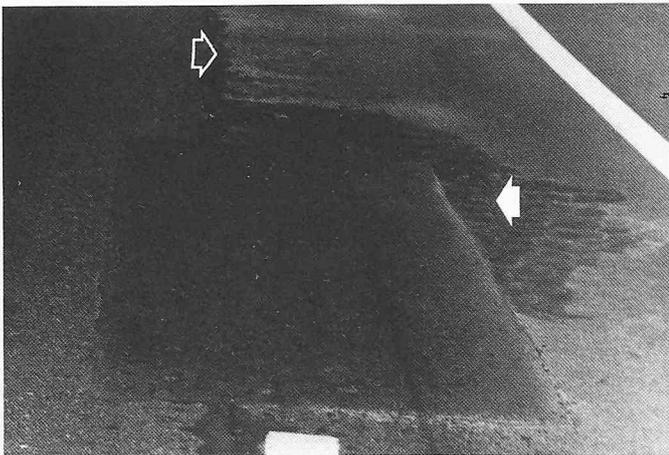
Erste Belagsschäden in der 1. Einbauetappe längs Mittelnaht
